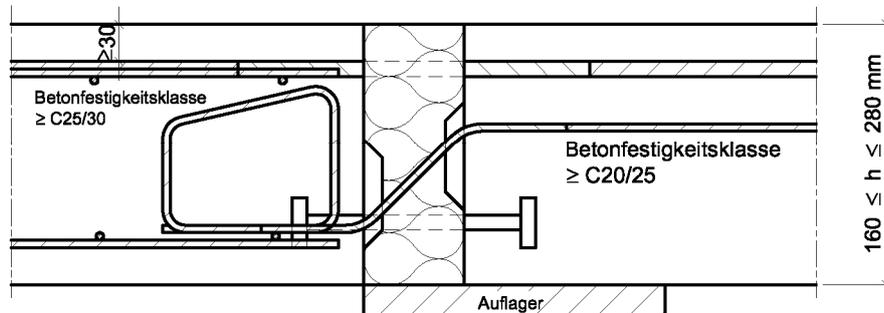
Beispiel Schöck Isokorb Typ KX mit integrierter Aufhängebewehrung
